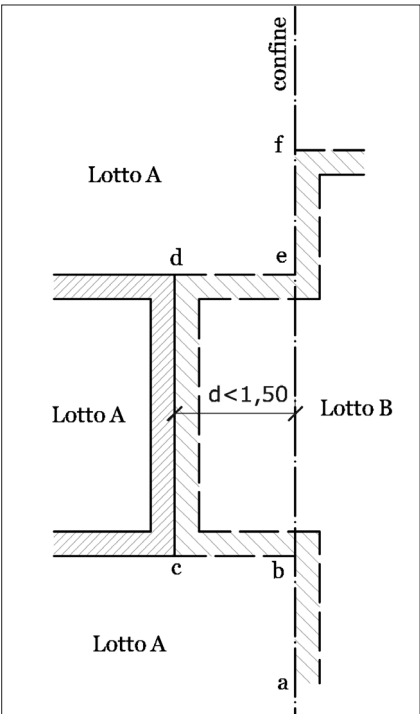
Se B si appoggia al muro di confine rendendolo comune può sopraelevare solo arretrando di 3 m.
